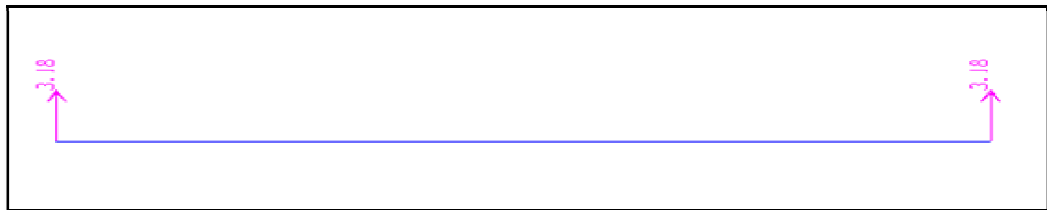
14 Vigueta T1 con las cargas aplicadas y las respectivas reacciones.
